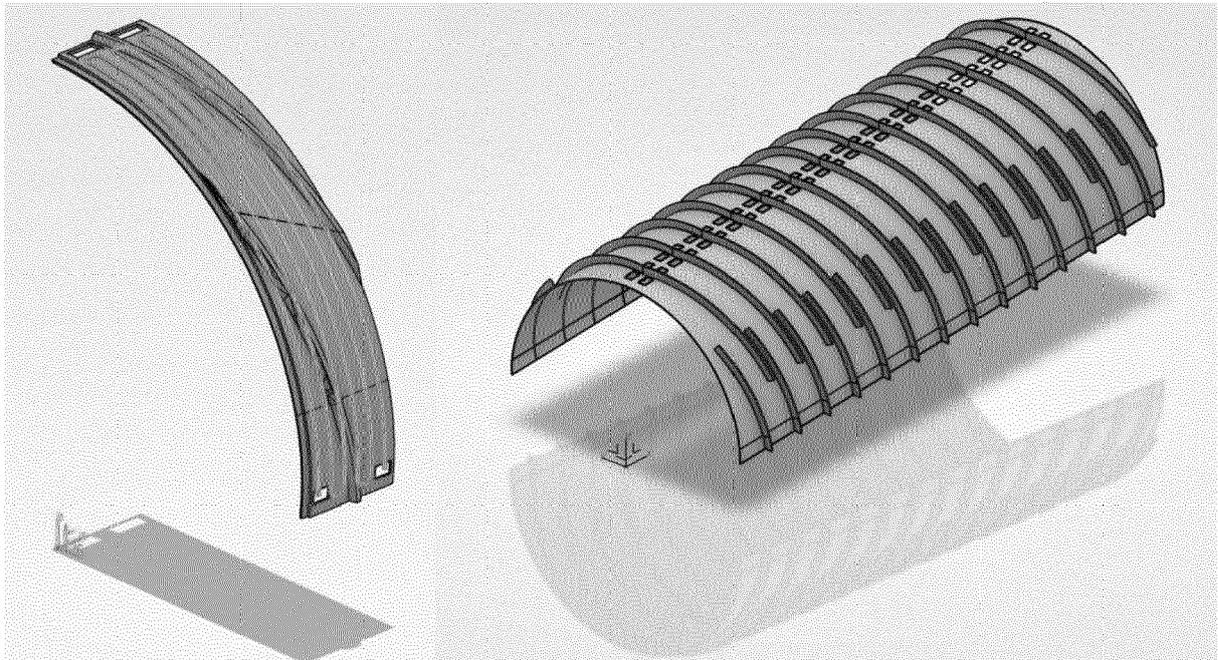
Elément de parement (gauche) et assemblage du parement à l'échelle de l'ouvrage (droite).
